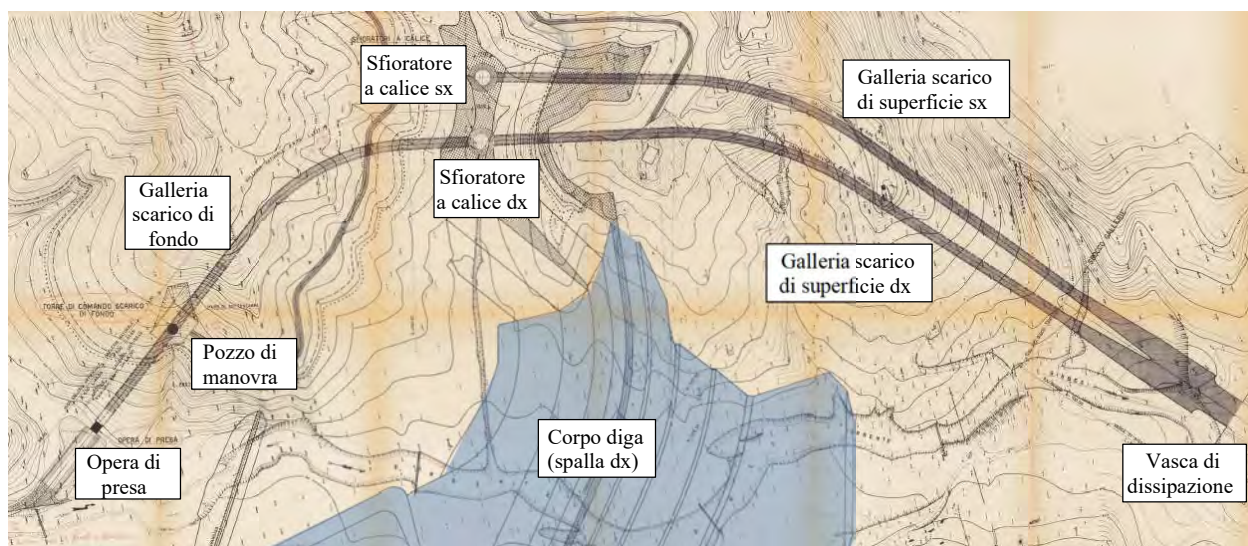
Diga di Gibbesi – Planimetria della diga e posizione delle gallerie di scarico (disegno di progetto del 1982)
